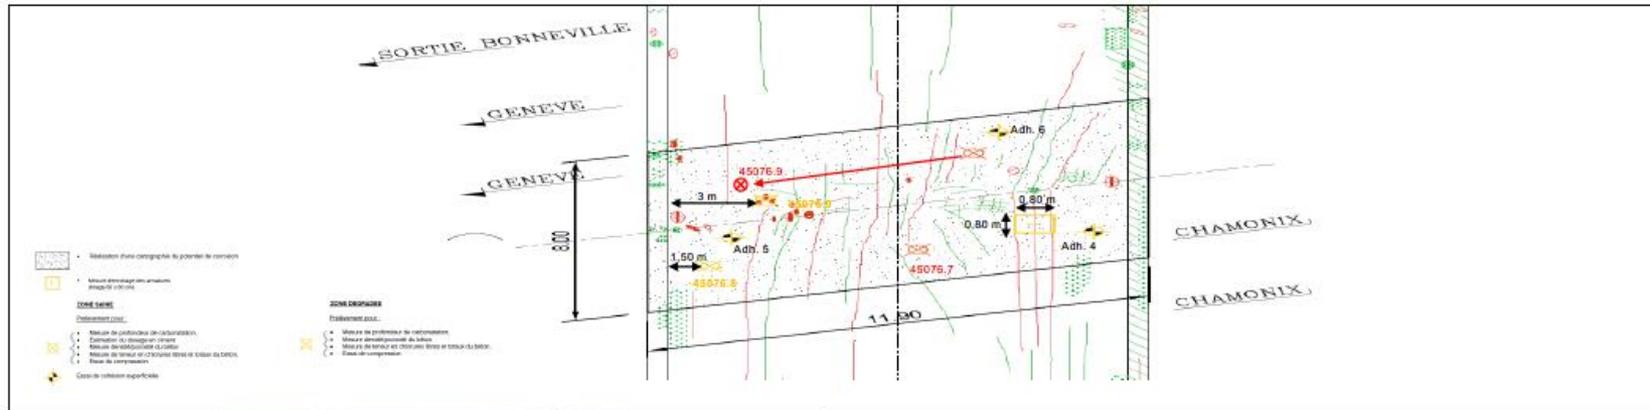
Implantation sur plan (source IDA) et aperçu de la zone 1 en sous-face de tablier
